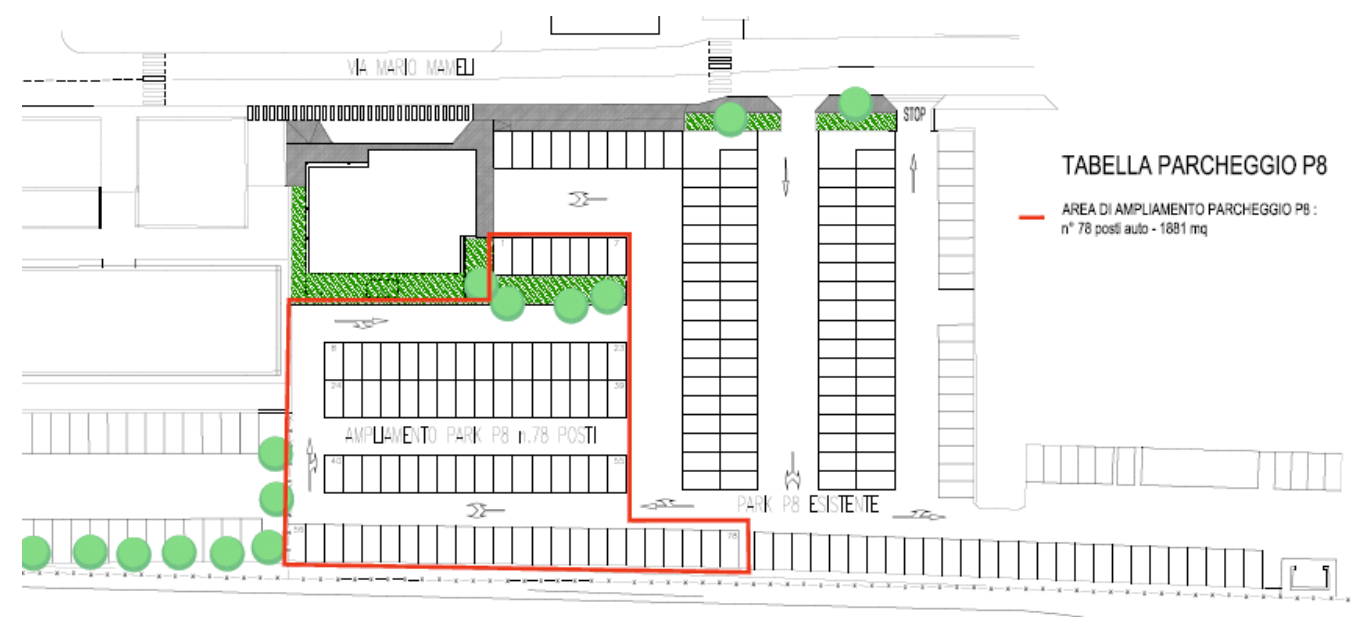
parcheggio a raso coperto con struttura fotovoltaica P8: planimetria
